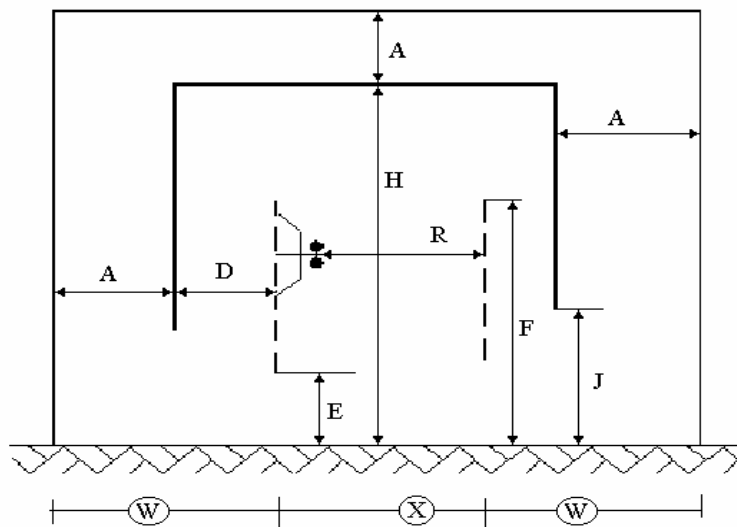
(b) – Espaçamento para instalações internas – circulação por mais de um lado
